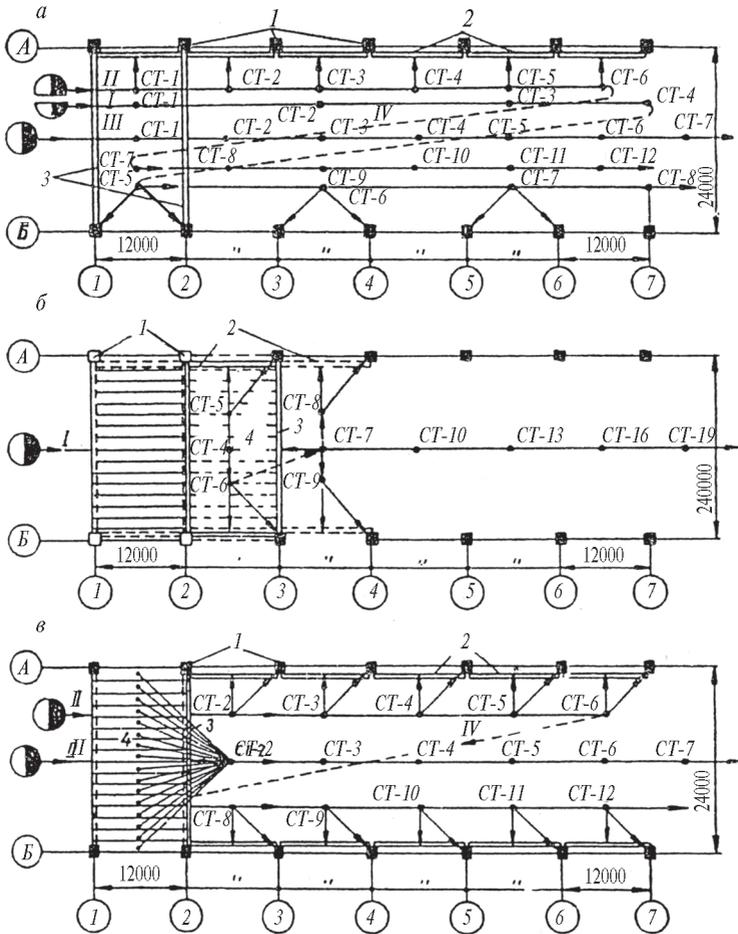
Схемы расстановки стреловых кранов при монтаже несущих конструкций одноэтажного промышленного здания:
